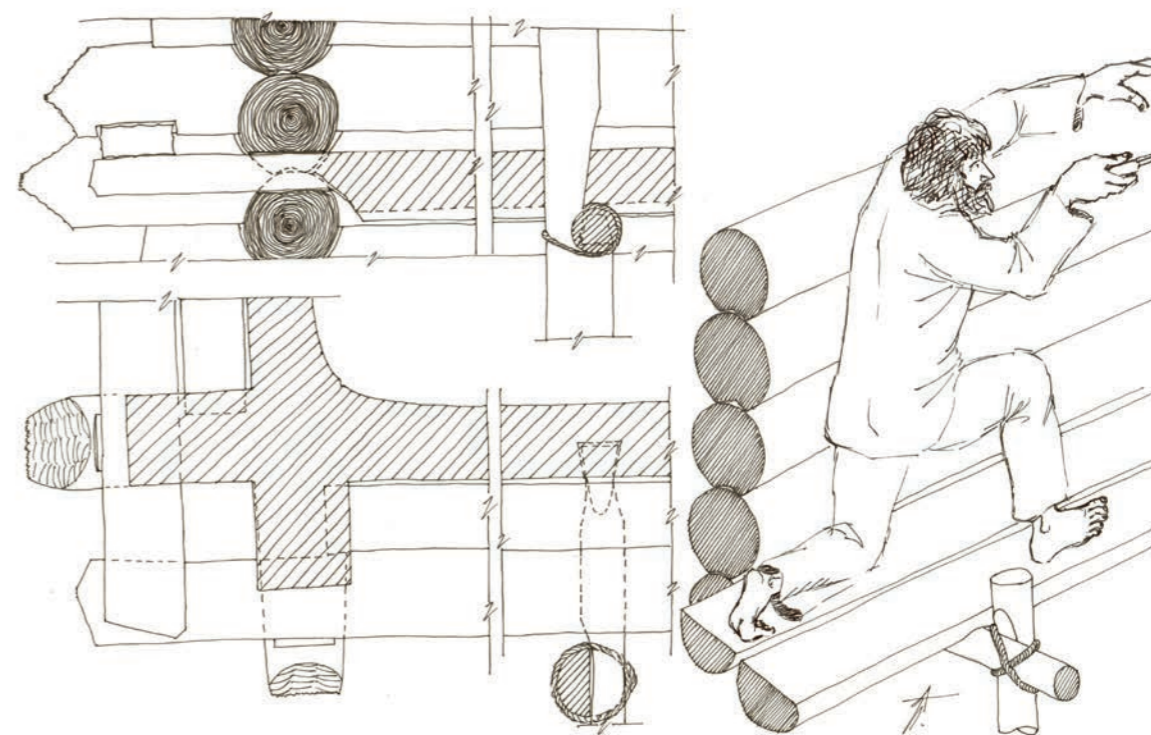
Конструкция наружных лесов, использовавшихся при строительстве храма
